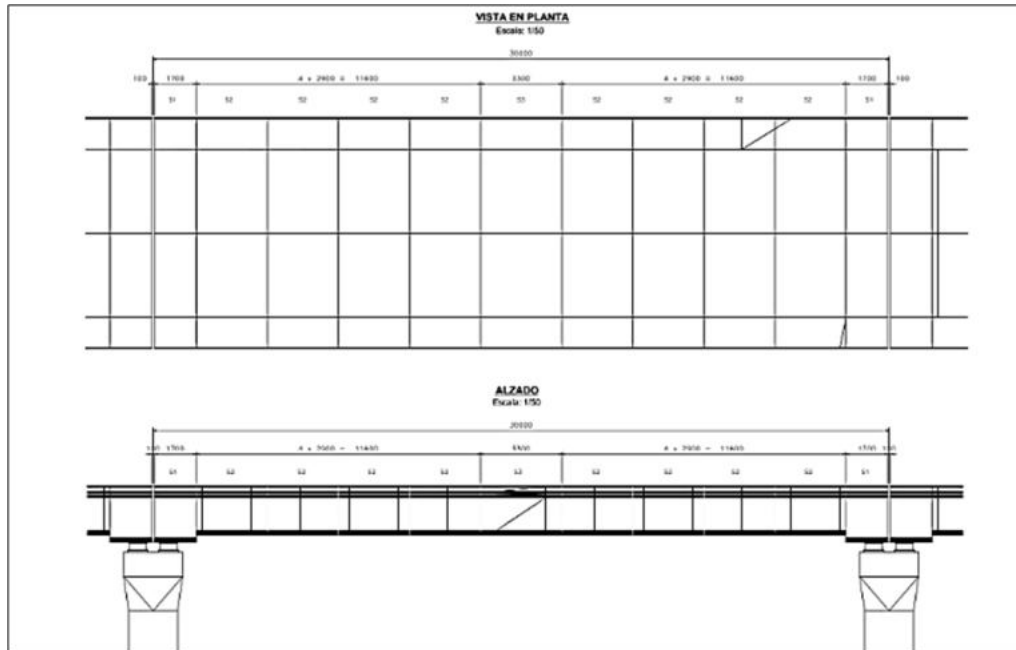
Planta y sección longitudinal del viaducto, tramo típico
